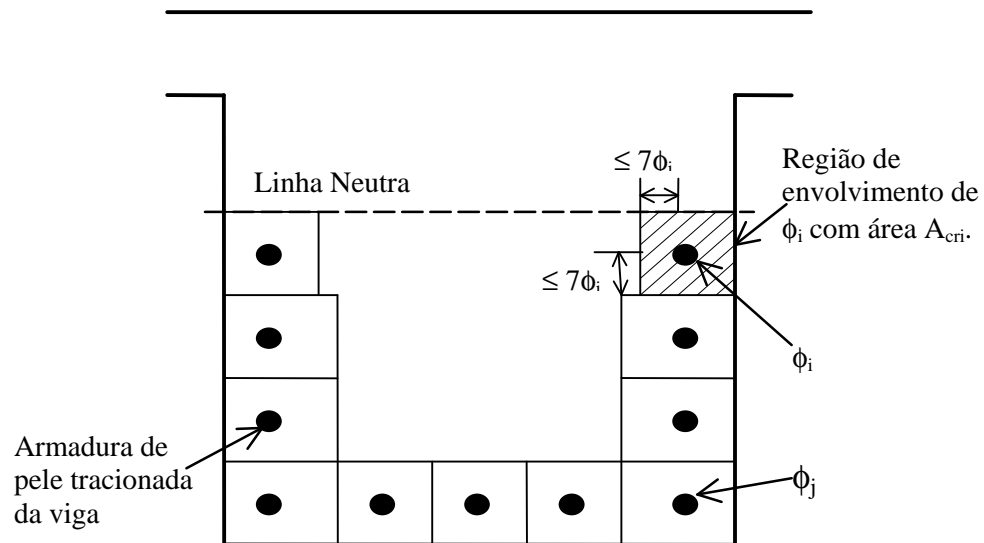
Concreto de envolvimento da armadura (Fig. 17.3, NBR 6118/2003)
